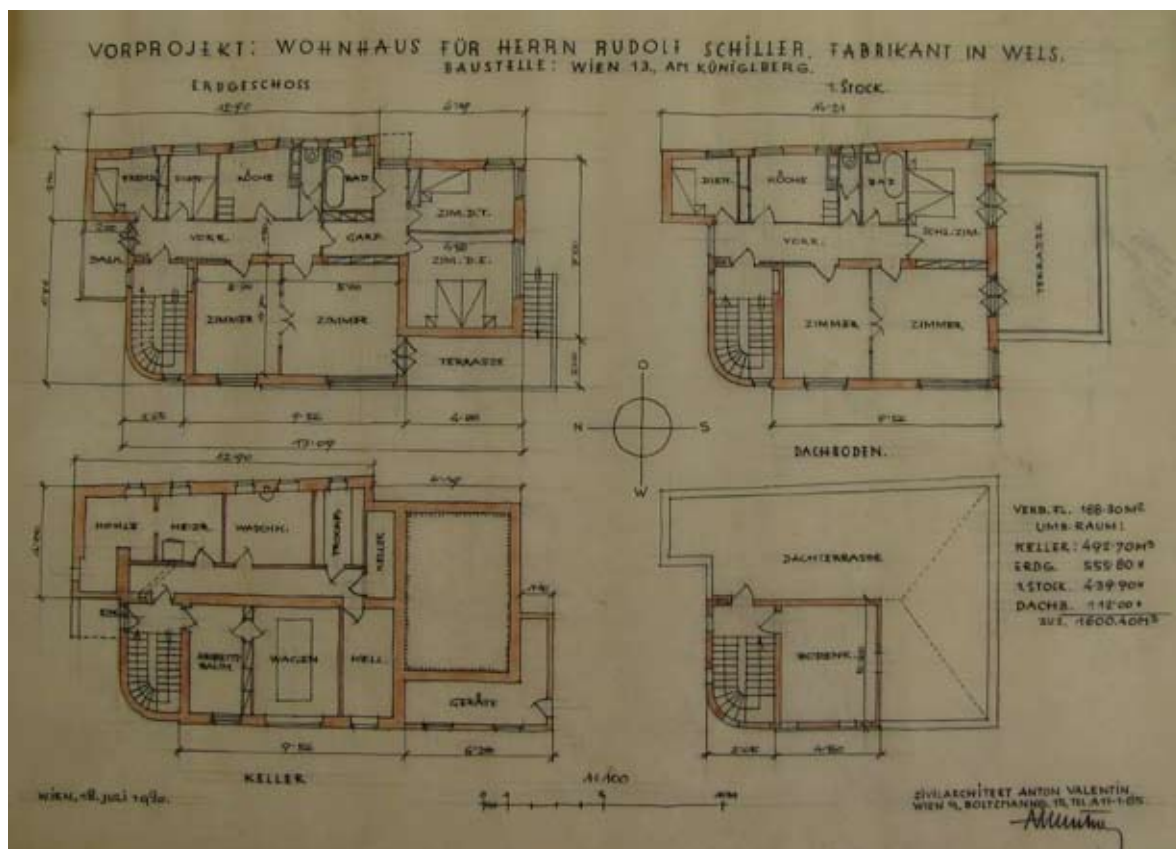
Plan 14.2: Anton Valentin. Vorprojekt: Wohnhaus für Herrn Rudolf Schiller, Fabrikant in Wels. Baustelle: Wien 13, Am Königlberg. Grundrisse. Maßstab 1:100. 18. Juli 1930.
